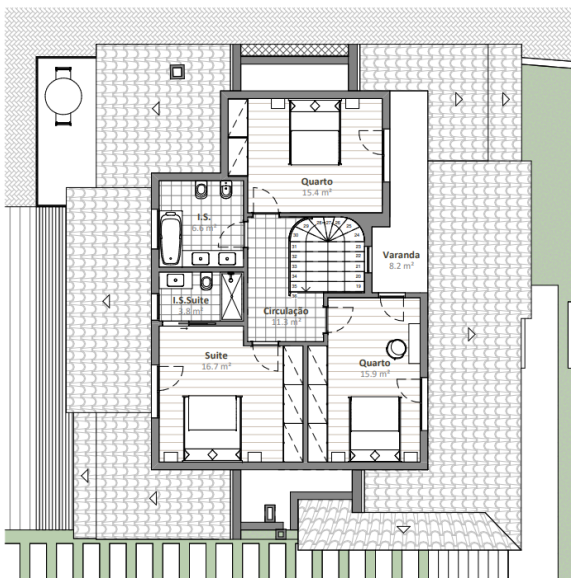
Proposto - Planta do piso 1 (EP_R00).
